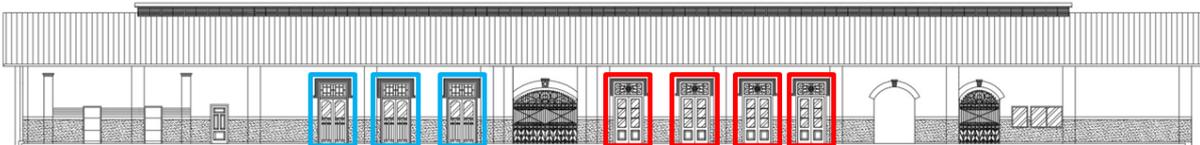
Keseimbangan fasade bangunan Stasiun Cimahi
